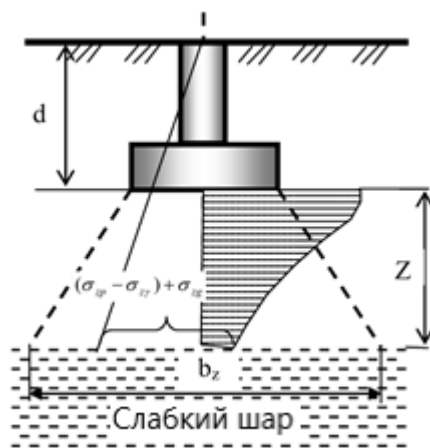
Розрахункова схема фундаменту до перевірки слабкого підстиляючого шару
